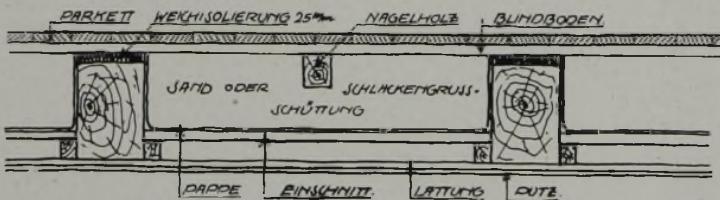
Balkendecke mit guter Dämmung gegen Körperschall und Wärmedurchgang. Die Schlackengrußfüllung ist zwar wärme-, aber wenig schalldämmend. Als Weichisolierung sind Dämmatten wirksam. Die Befestigung des Blindbodens hat auf den Nagelhölzern zu erfolgen; eine Nagelung auf den Balken fördert die Schwingungsübertragung und ist unbedingt zu vermeiden.
